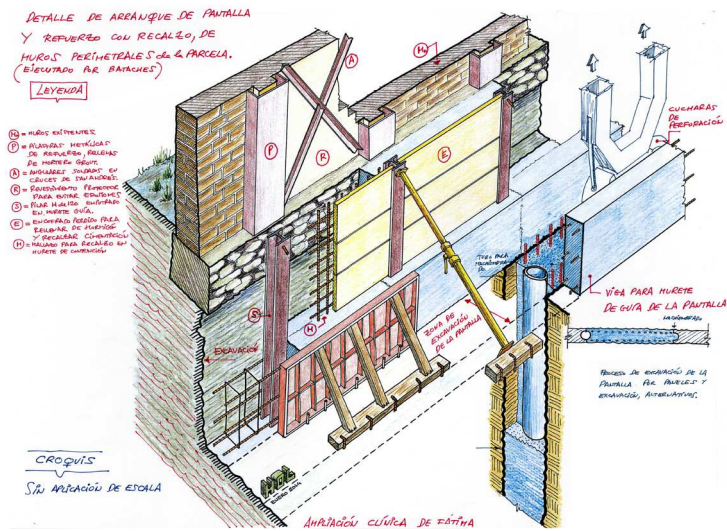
Cimentación con pantalla y recalzo de muro perimetral
